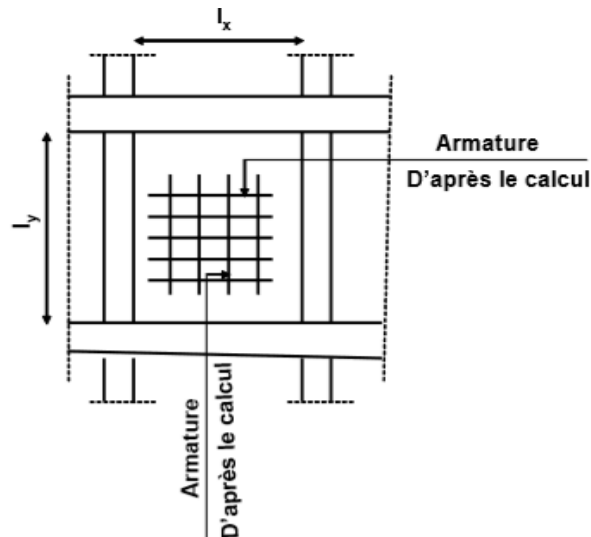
disposition du ferrailage d'une dalle qui travaille dans un seul sens
